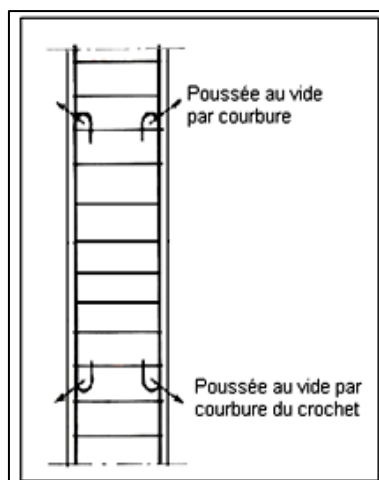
Poussée au vide dû aux crochets des armatures.
